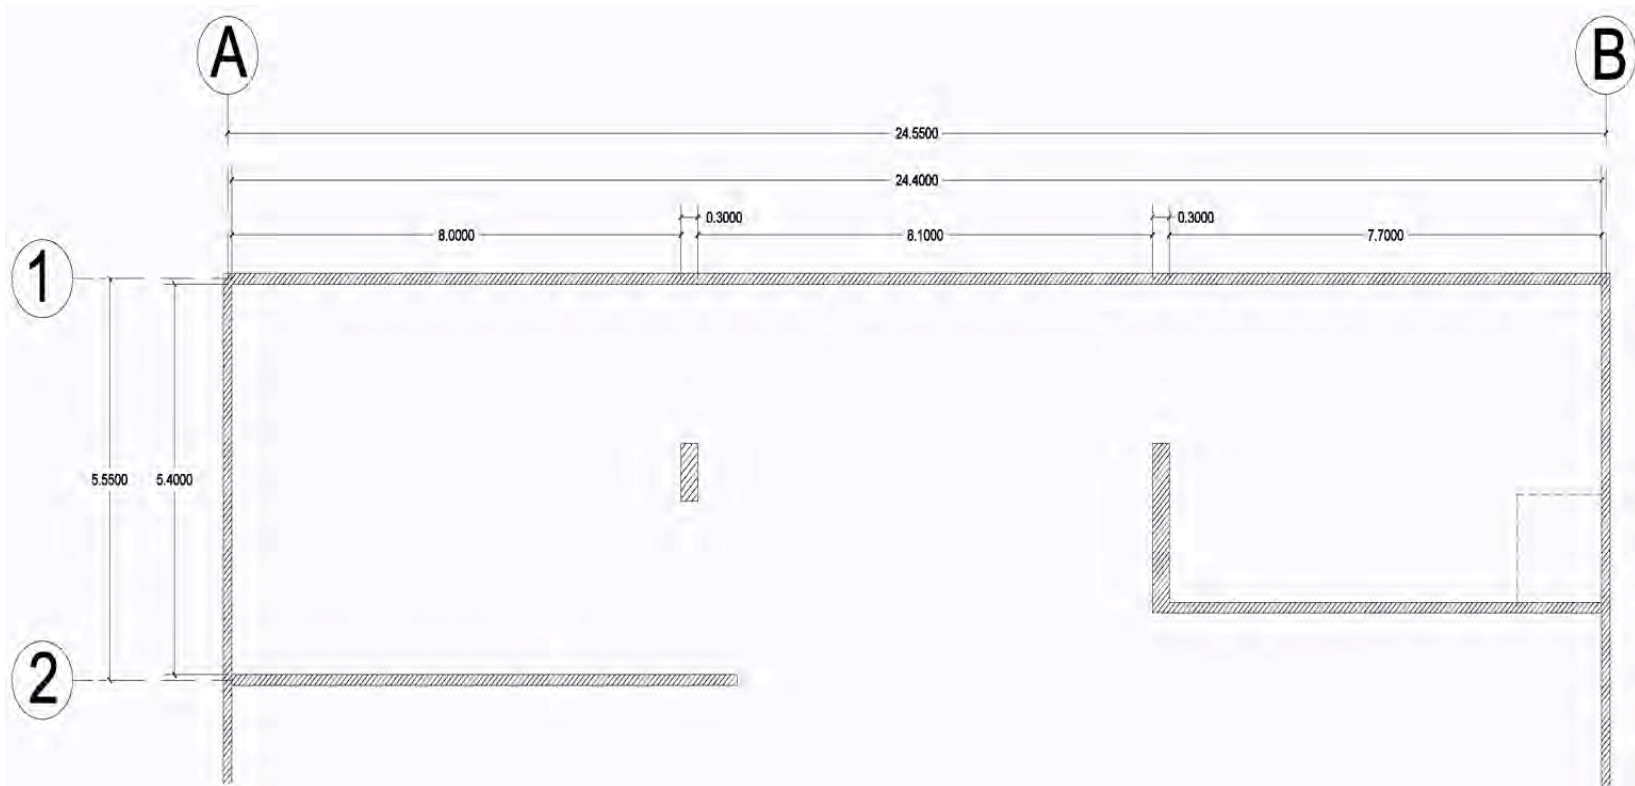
Planta arquitectónica Galería de la Torre Universitaria.
